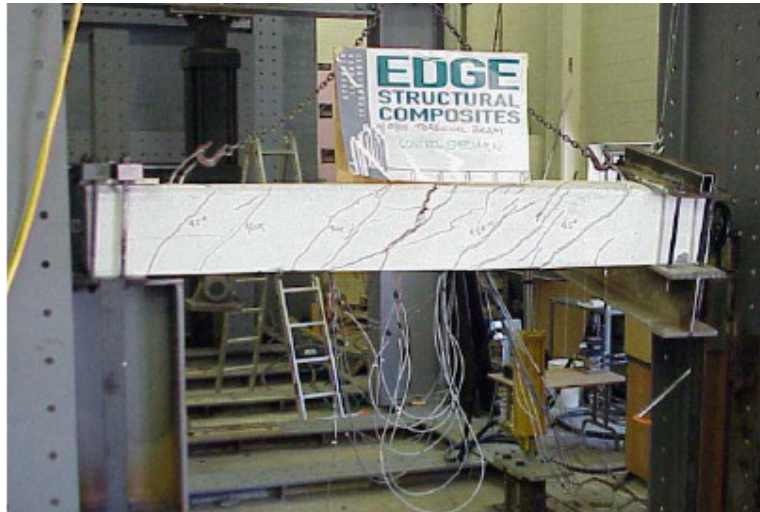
Fissuração devido à torção (Salom, 2004b).
